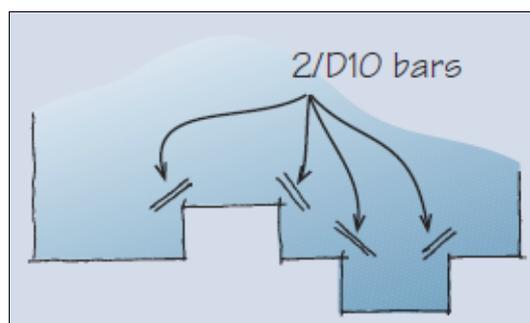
Adoção de armaduras de reforço nos cantos reentrantes [7]
